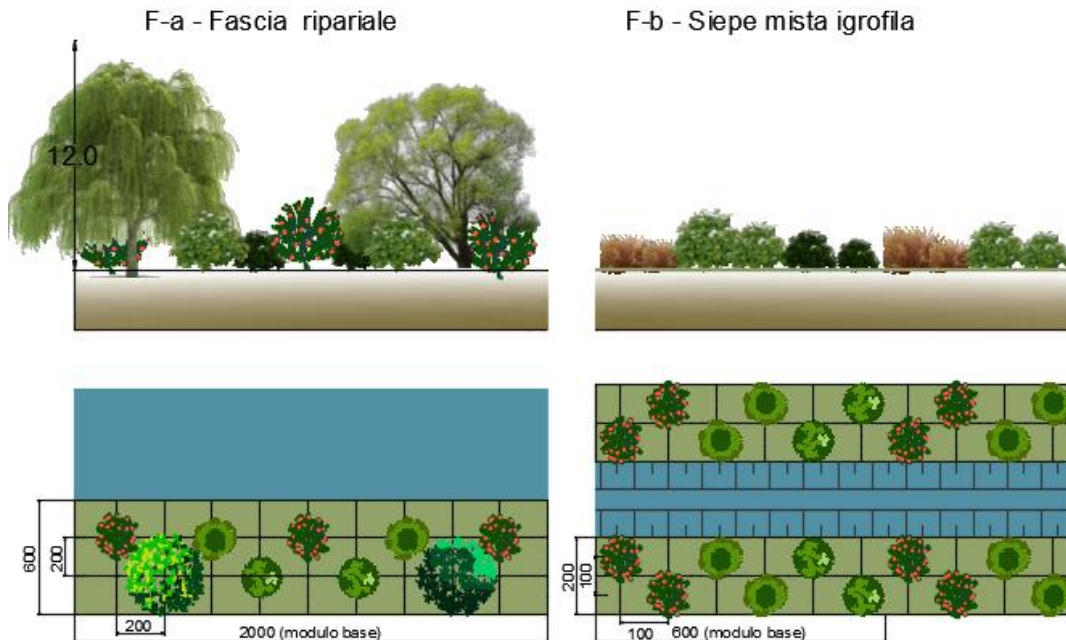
Modulo F – Sistemazione vegetale spondale
